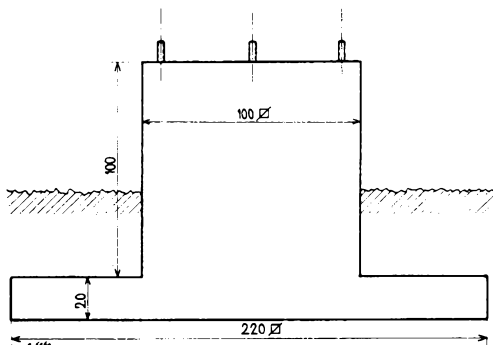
Deze fundatie werd ontworpen voor de antennemast van PAoSE. Het totale gewicht bedraagt ongeveer 4,25 ton. De aarde boven de grondplaat naast de centrale kolom draagt door zijn gewicht ook nog bij tot de stabiliteit. In de beton is een bevlechting opgenomen. Van het ingegoten „kader“ steken de drie draadeinden boven het blok uit. In verband met de hoge grondwaterstand is het blok niet dieper dan 60 cm ingegraven.
